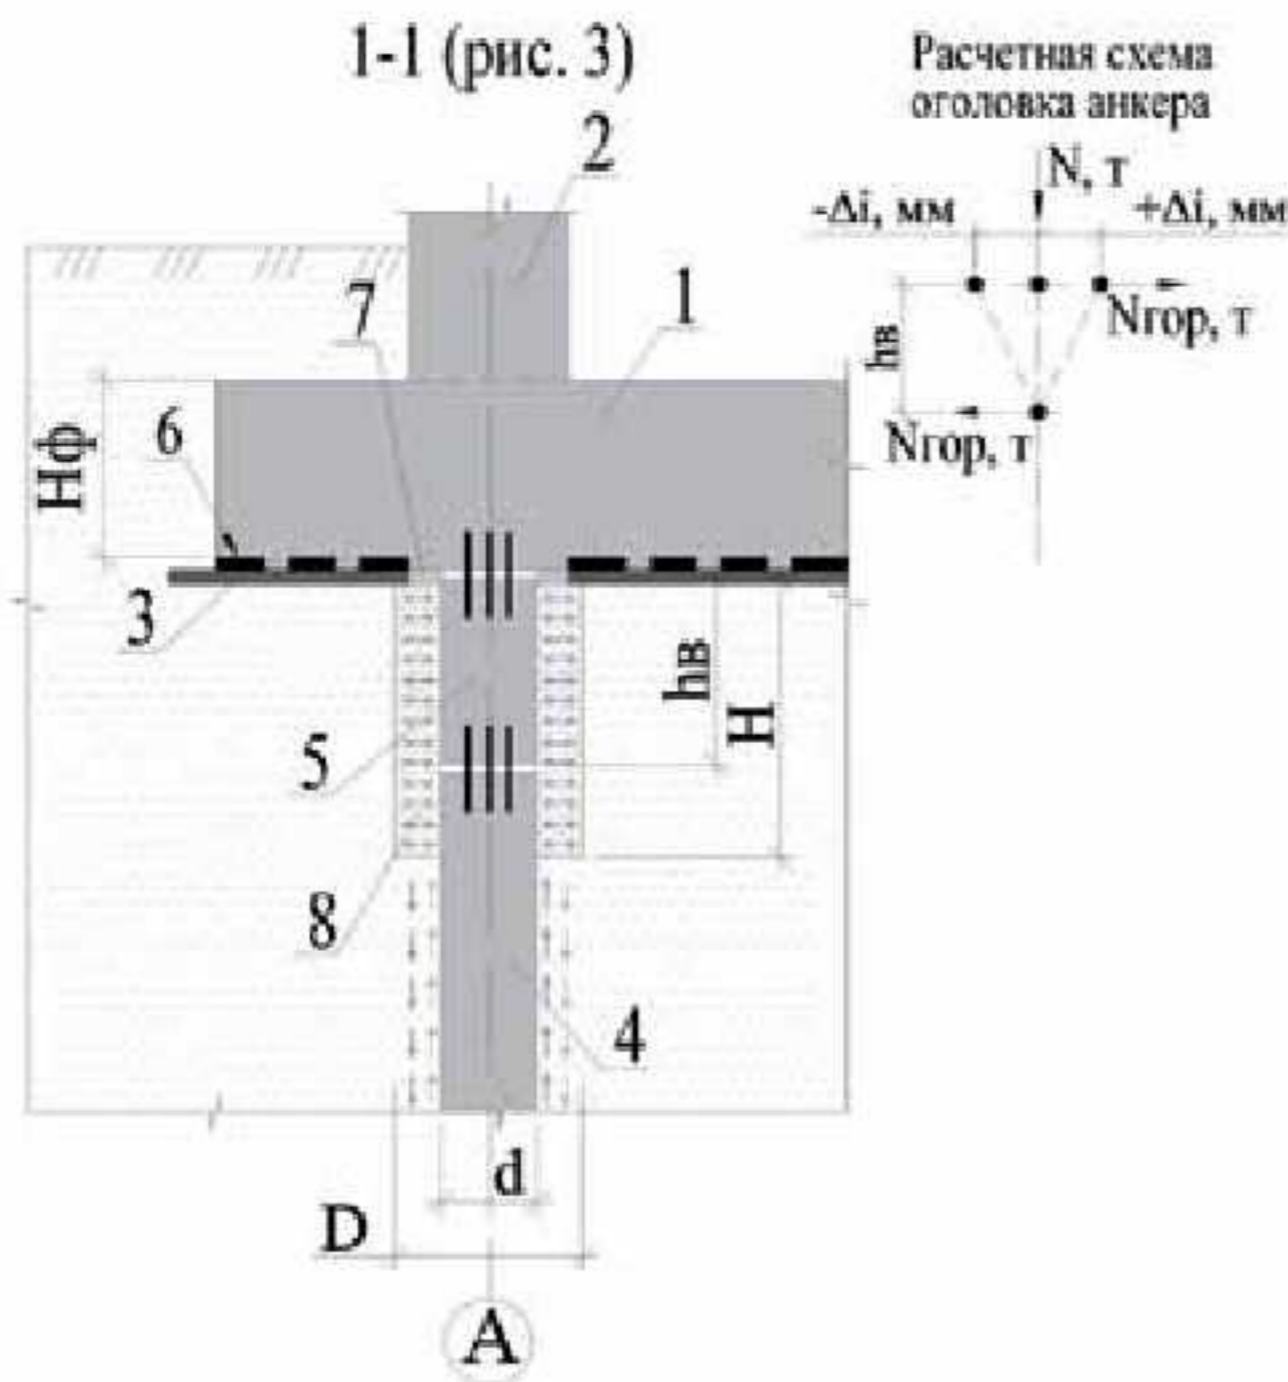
Система изоляции фундамента от вертикальной составляющей сейсмической нагрузки: 1 – фундаментная плита; 2 – колонна каркаса; 3 – бетонная подготовка – топографический слой; 4 – контурный анкер трения; 5 – шарнирно-подвижная вставка; 6 – шов скольжения–демпфер сухого трения; 7 – антисейсмический деформационный шов-демпфер вязкого трения; 8 – заполнение упруго-вязким материалом.
